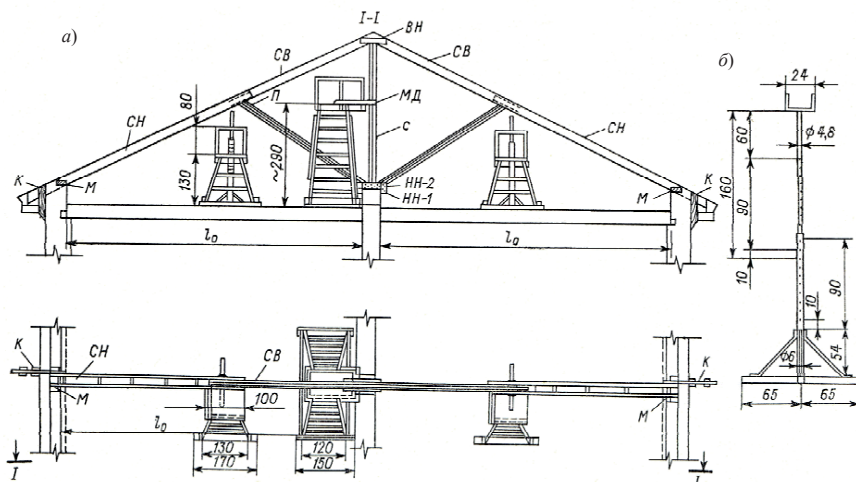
Монтажная схема дощатой стропильной фермы: а – план-схема расположения монтажных приспособлений: НН – нижние накладки; ВН – верхние накладки; С – стойка; МД – монтажная доска; К – кобылки; СН – нижний элемент стропильной ноги; П – подкос; М – мауэрлат; б – раздвижная стойка
